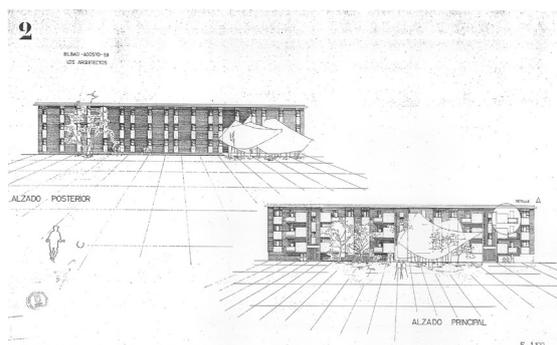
Tipo I-3, Avance proyecto. Plano de alzados. 1959.
